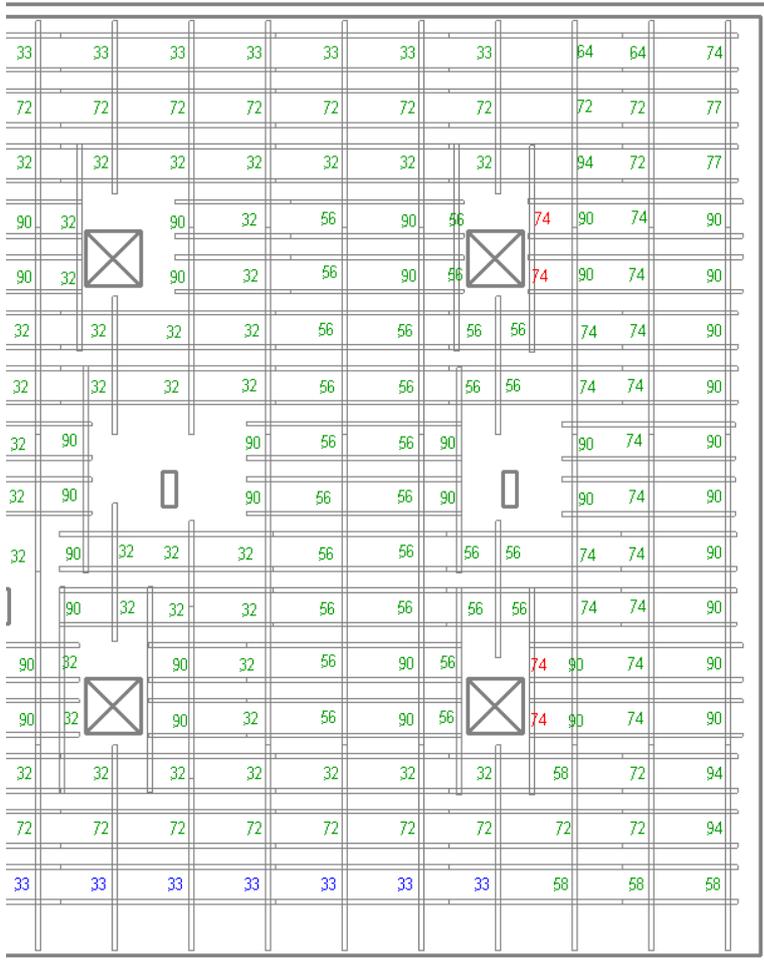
Ballastplan (Planausschnitt als Beispiel)
